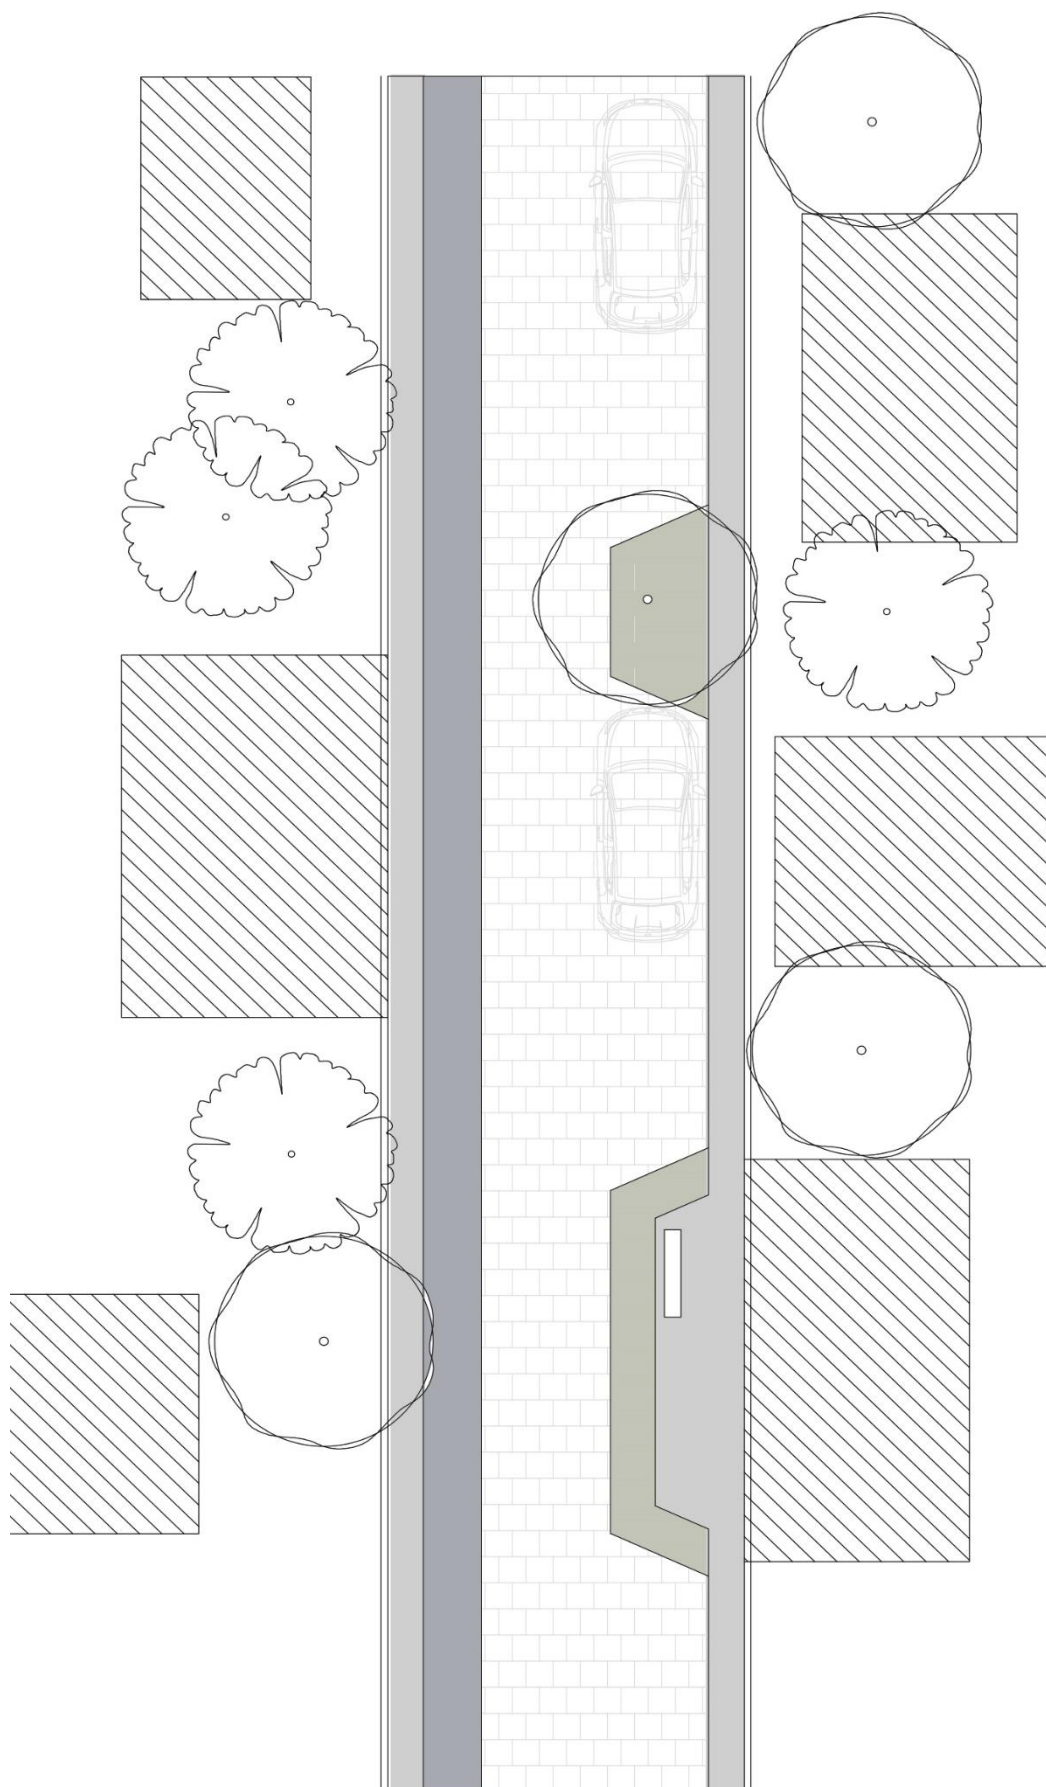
Planta de trecho da rua São João. Elaborado pelo autor, 2023
